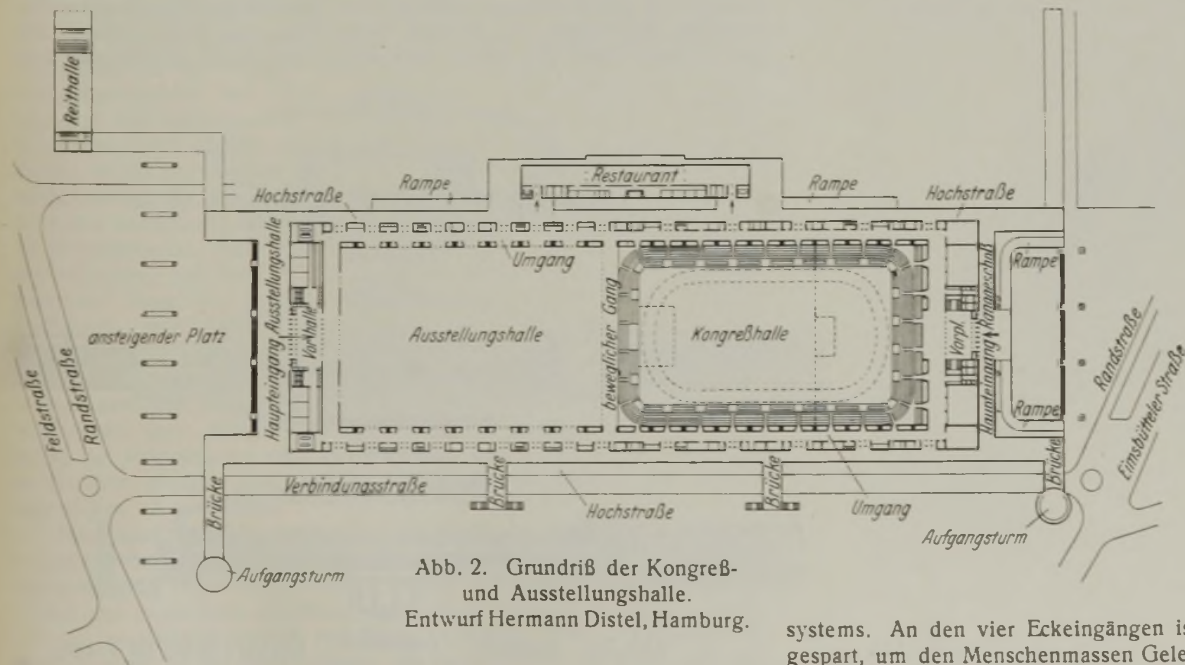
Grundriß der Kongreß- und Ausstellungshalle.
